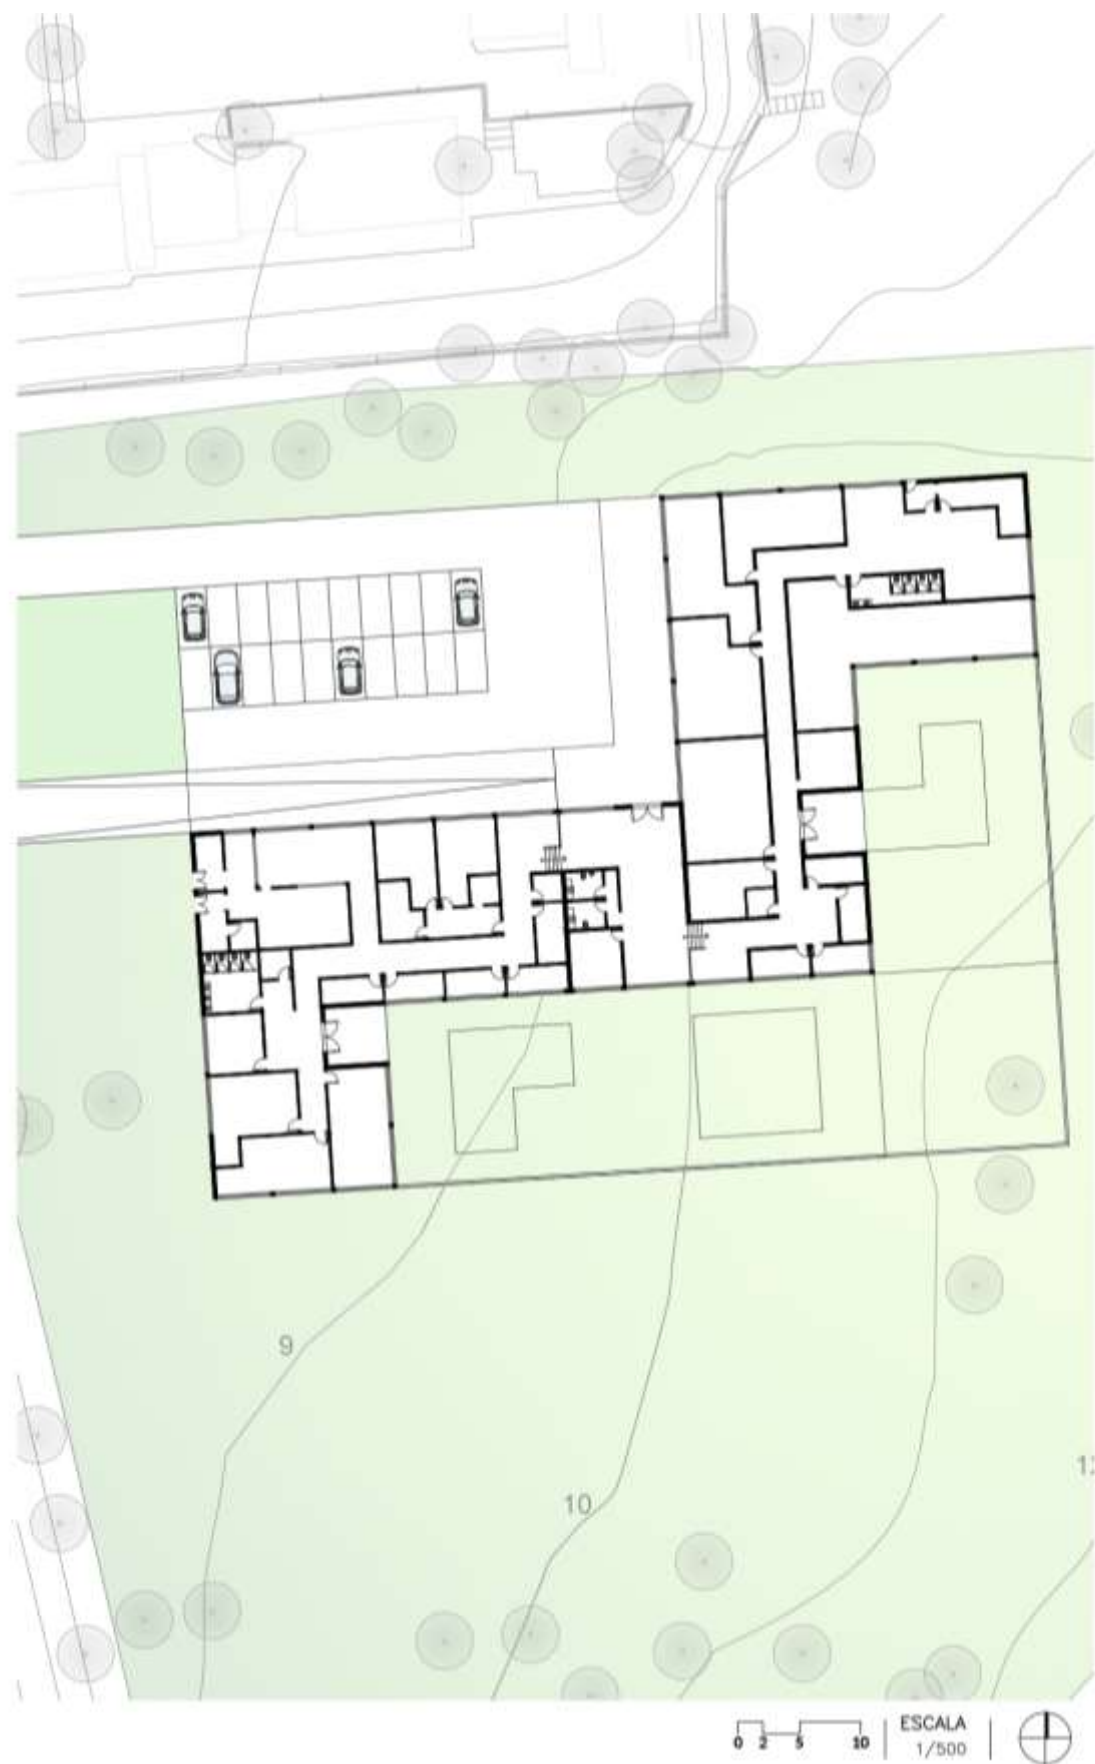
Planta de piso térreo. Autor: Autoria própria
